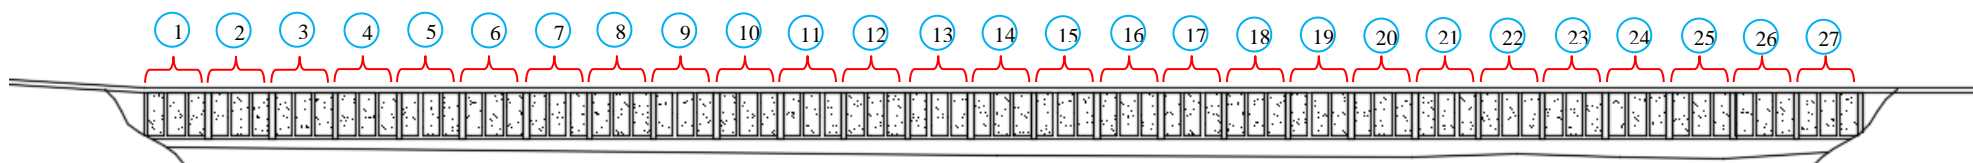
schéma d'une coupe longitudinale du barrage de Tadjmout
